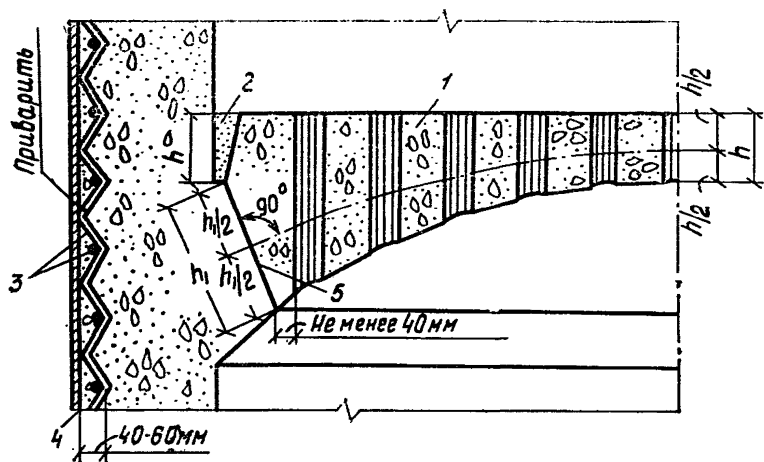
Конструкция купола перекрытия с технологическими отверстиями из жаростойкого бетона для круглого теплового агрегата
